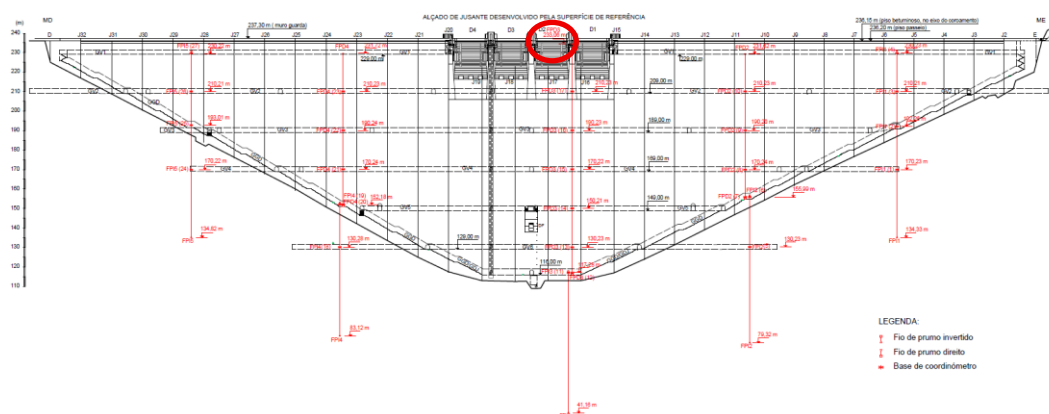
Alçado planificado com a localização dos fios de prumo.
